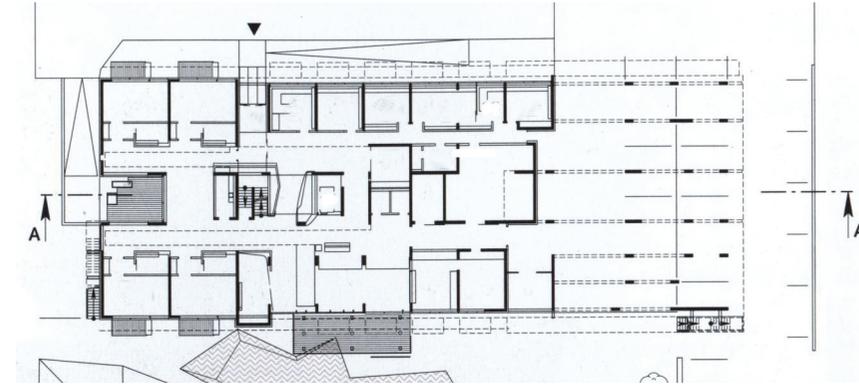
Grundriss Erdgeschoss M 1:750
